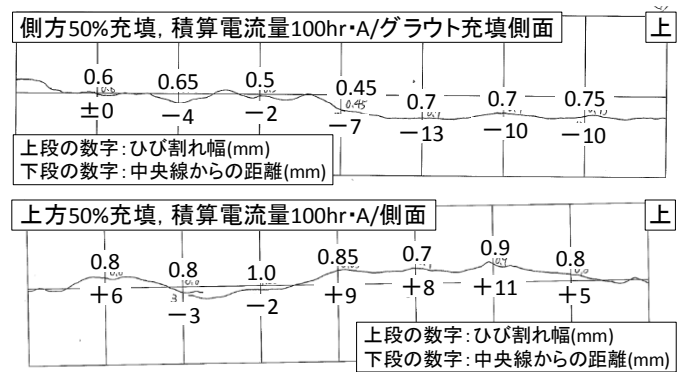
コンクリート表面のひび割れ発生状況の一例
